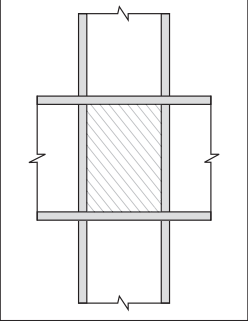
Panneau d'âme encadré par des raidisseurs horizontaux et les semelles du poteau
